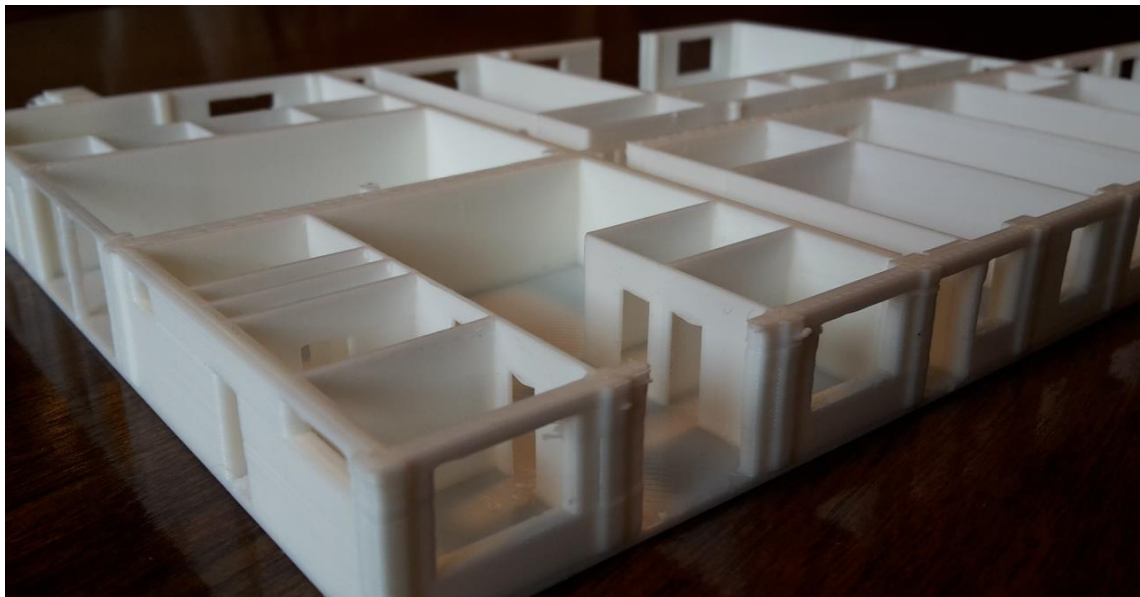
Detalle de la distribución de superficies de la planta baja
